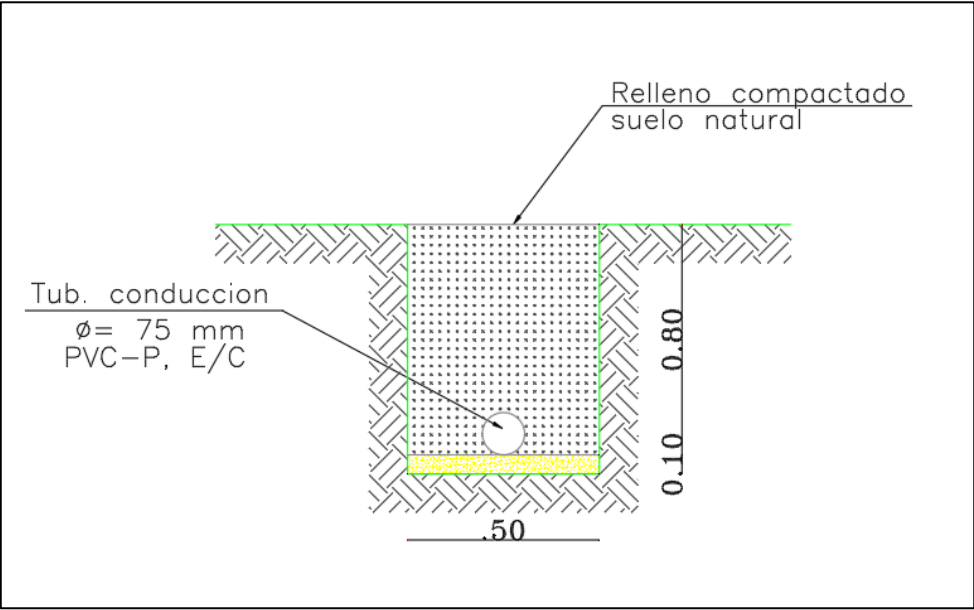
Sección transversal de la zanja para las tuberías [Barahona & Rivas, 2022]
